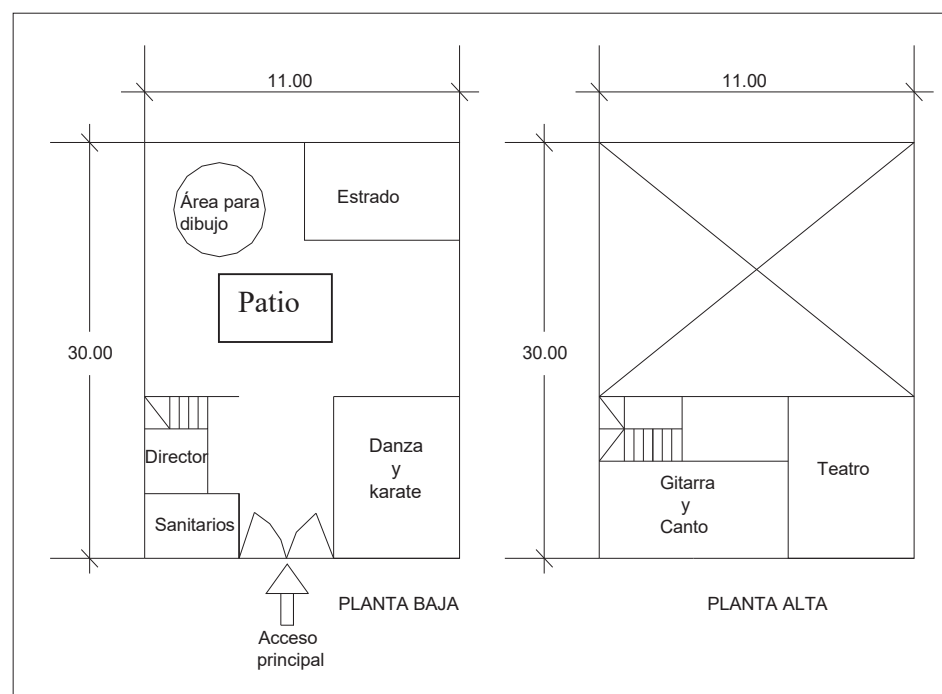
Croquis de las plantas arquitectónicas de la casa de la cultura de Huandacareo.
